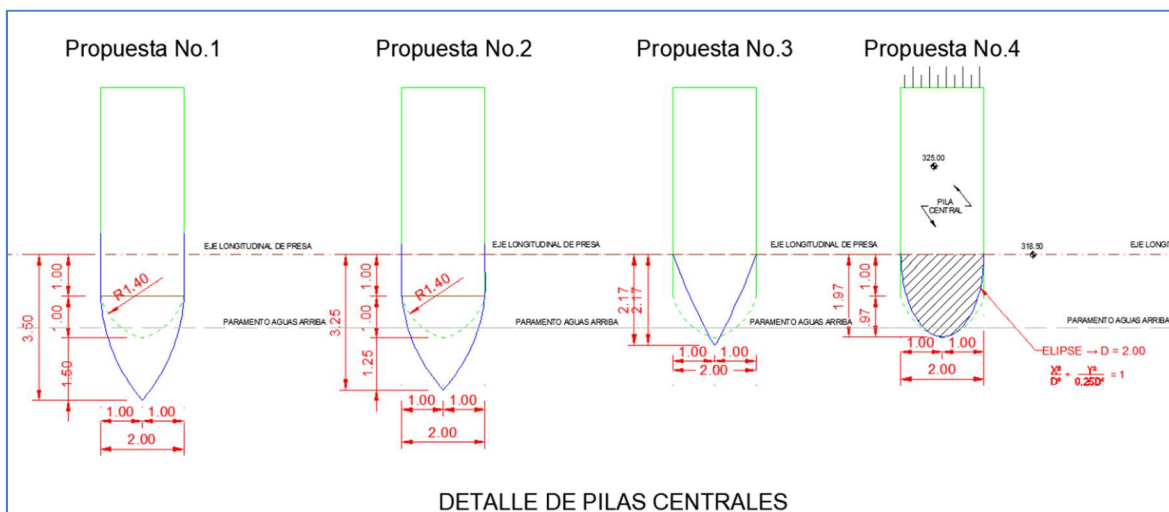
Propuesta para modificar la geometría de las pilas intermedias
